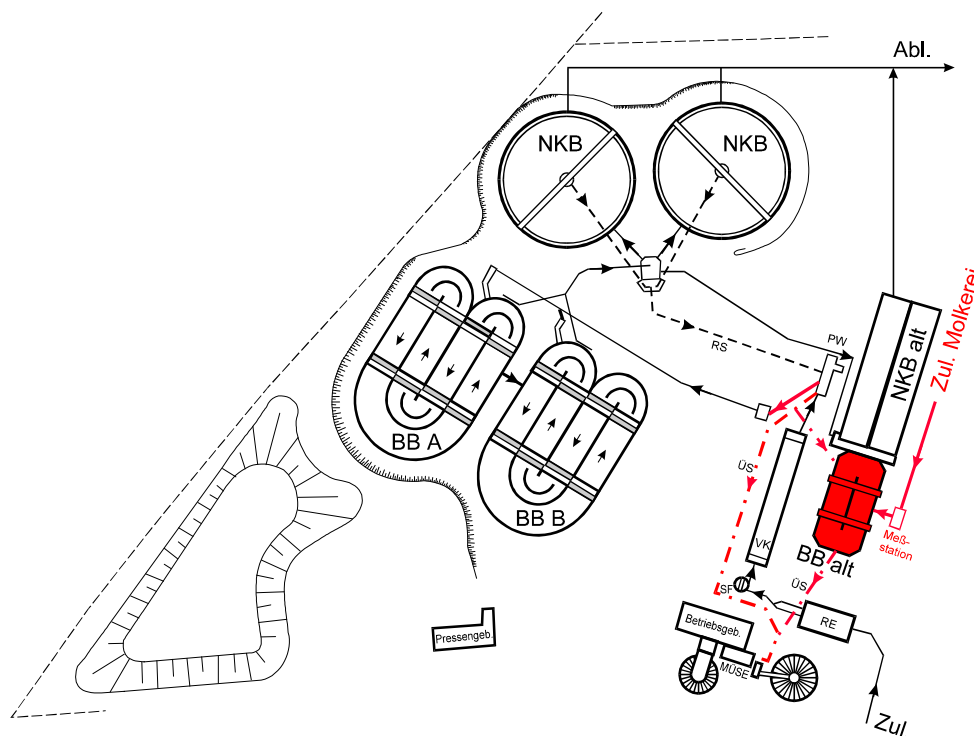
Lageplan der KA Bad Vöslau mit Leitungsführung bei Variante 4
